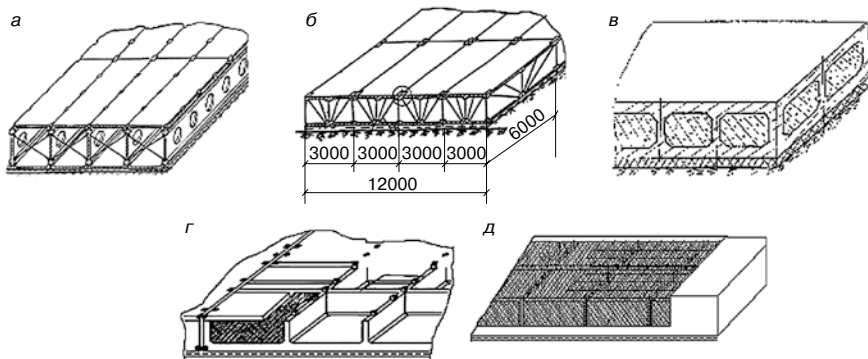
Пространственные фундаментные платформы ПФП (варианты): а, б – сталежелезобетонные платформы с вентилируемым подпольем для вечномерзлых грунтов [5, 6]; в – монолитная ПФП со встроенной теплоизоляцией [4]; г, д – сборный и сборно-монолитный варианты с теплоизоляцией [7]
